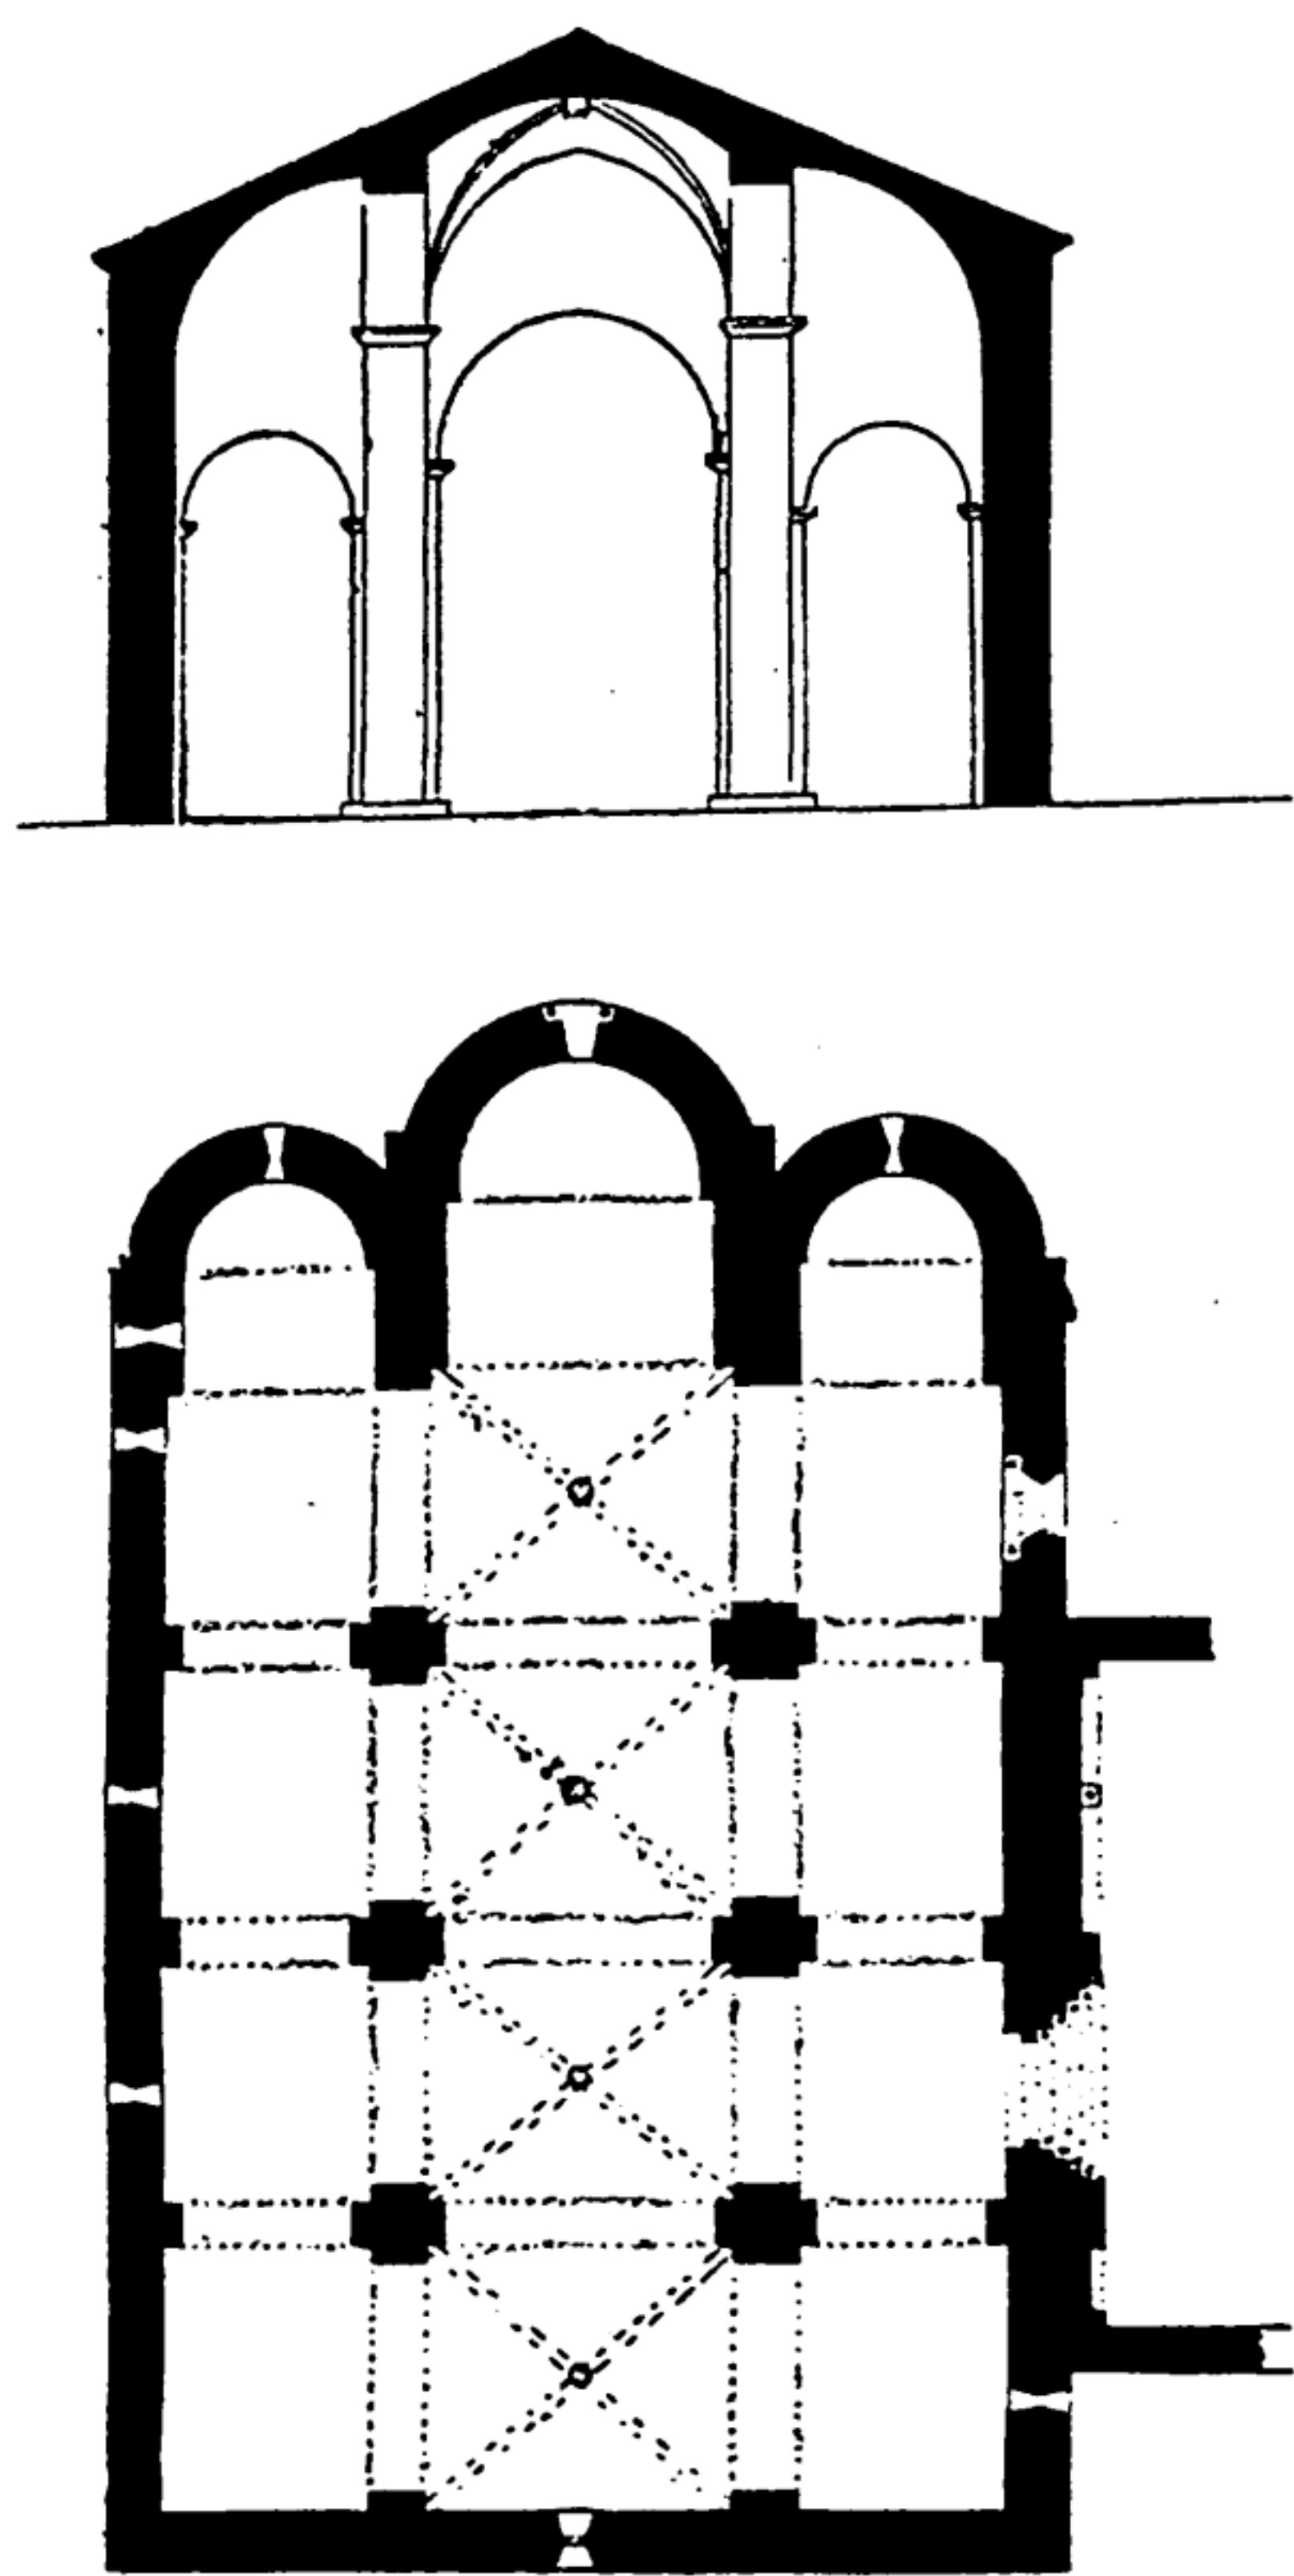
Planta y secció de l'Iglesia de Salardú.
